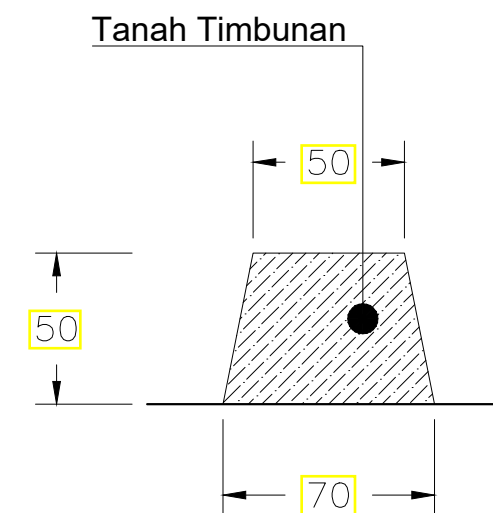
DETAIL SALURAN TERSIER DAN TANGGUL BANJIR (DETAIL - 5)
